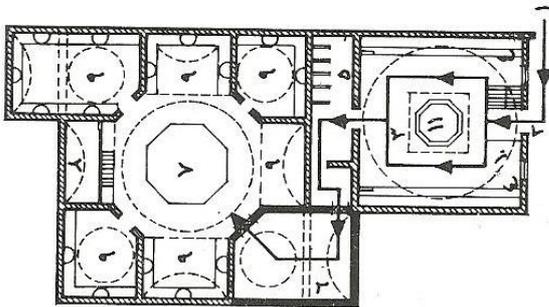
المدرسة الرستمية - مسقط أفقي
